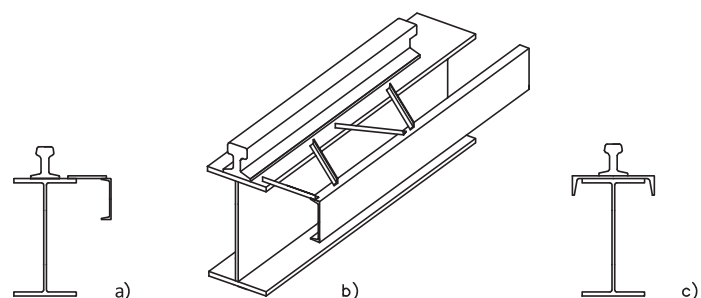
Sugestão de estrutura de contenção lateral (itens a e b); sugestão de reforço com perfil laminado U para viga de rolamento (item c).
